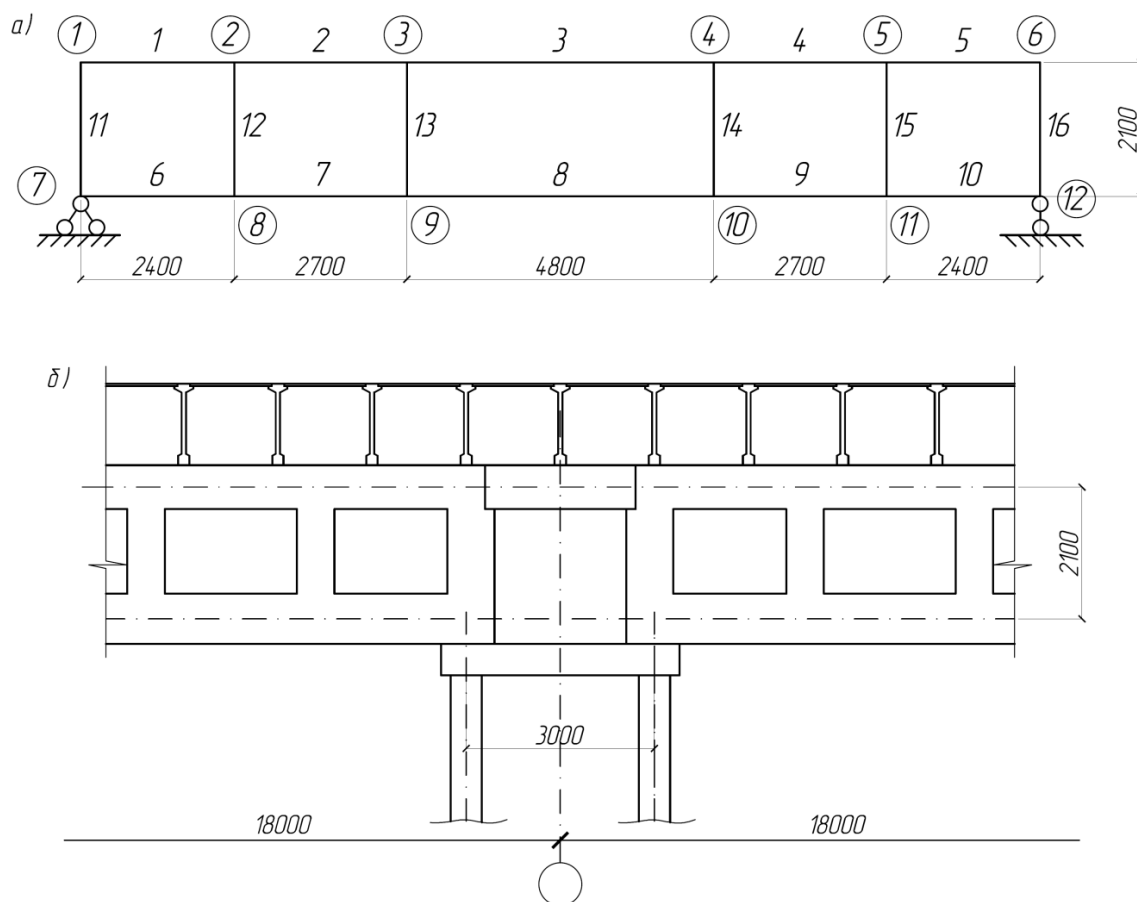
Подстропильная рама: а – нумерация элементов и узлов, б – схема опирания смежных рам на спаренные колонны
